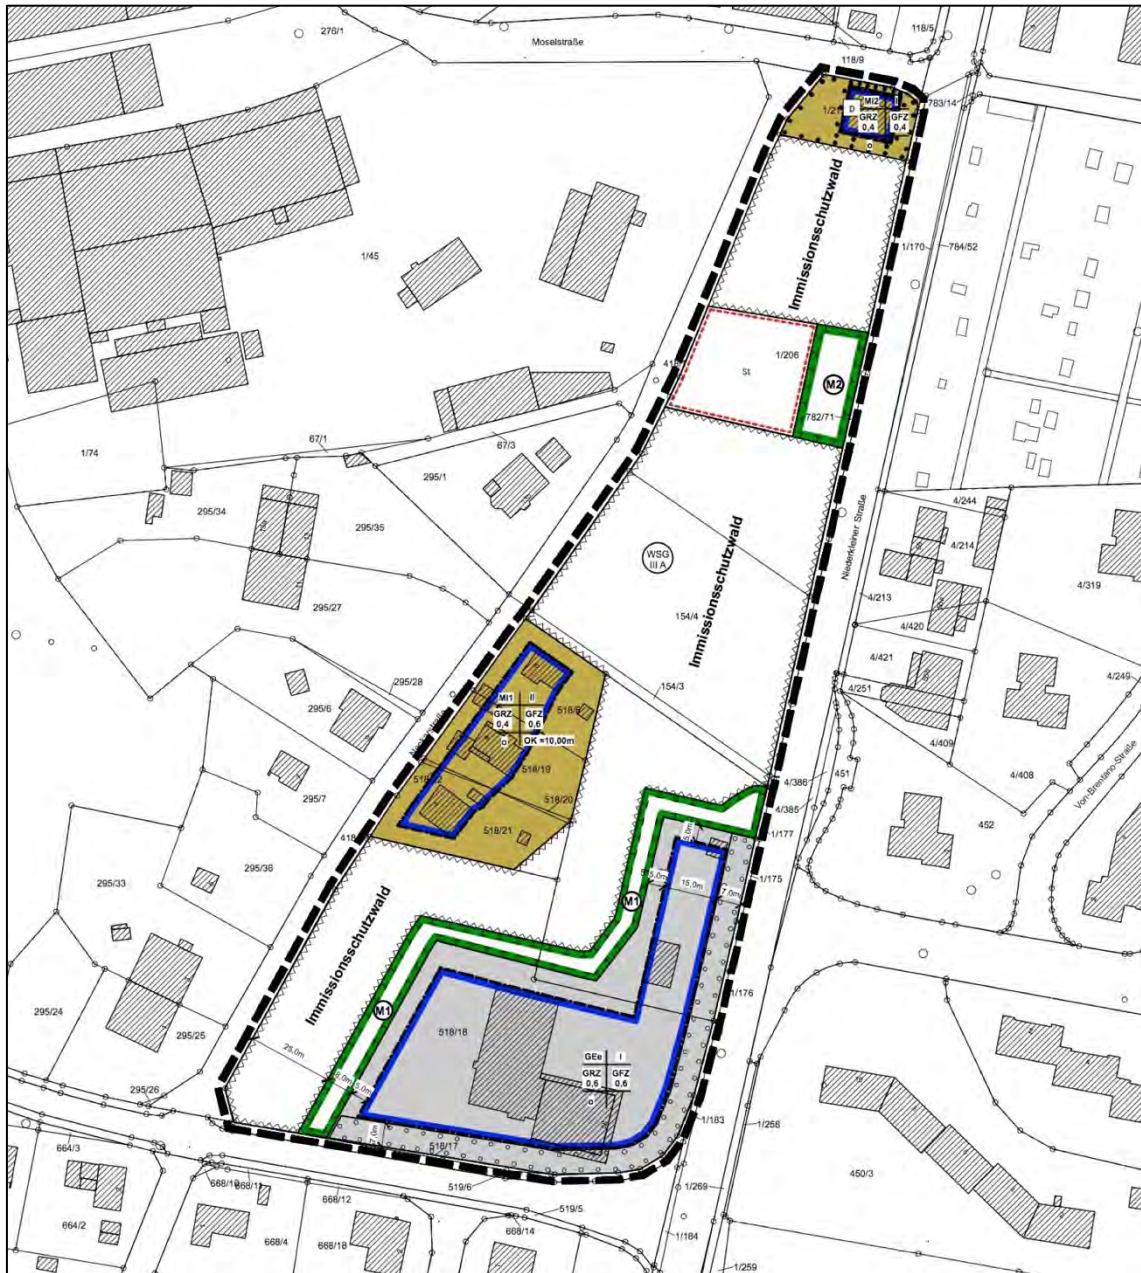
Bebauungsplan - Bebauungsplan Nr. 69 „Östlich der Neckarstraße“
